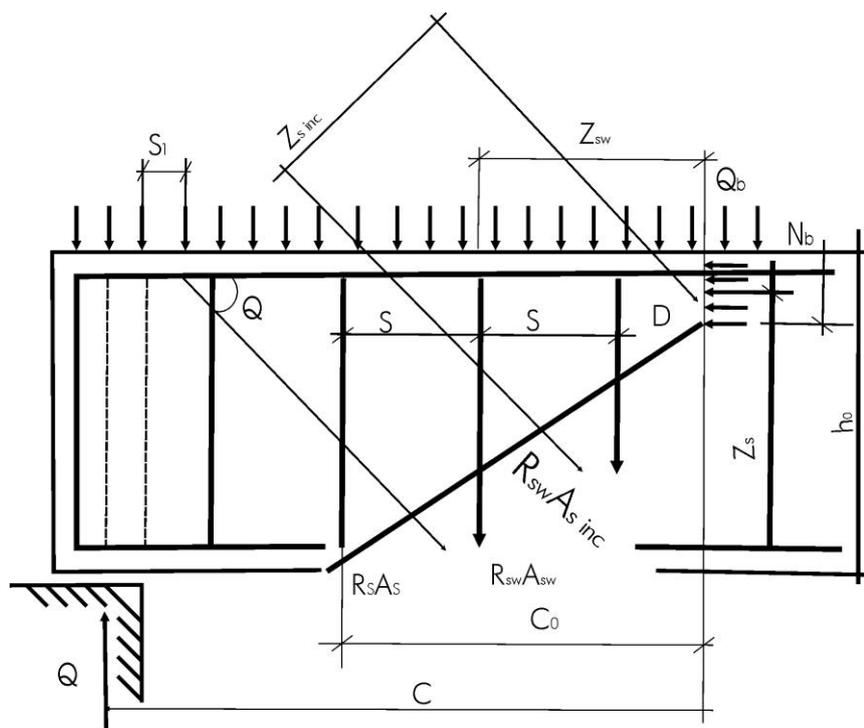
К расчету изгибаемого элемента по наклонному сечению
